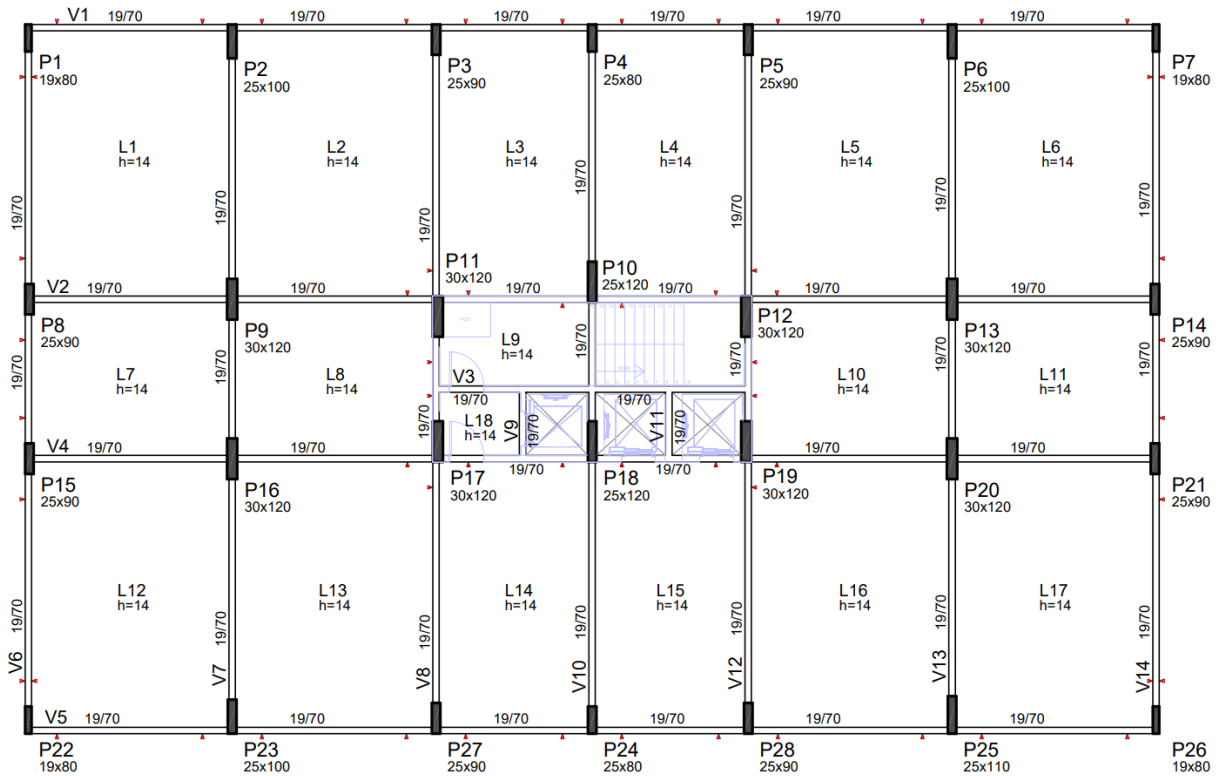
planta de fôrmas do 5º ao 8º pavimento - Tipo 4
